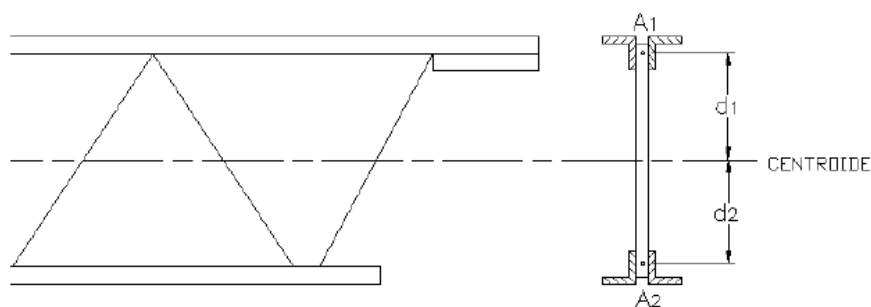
Cálculo de deflexión en vigas de alma abierta
